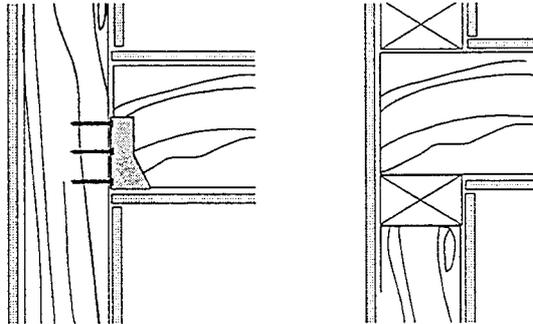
Anschluß Deckenbalken an tragende Wand
